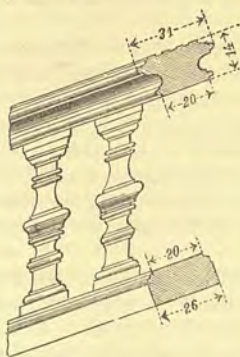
Parapetto scalone palazzo Madama a Torino.
